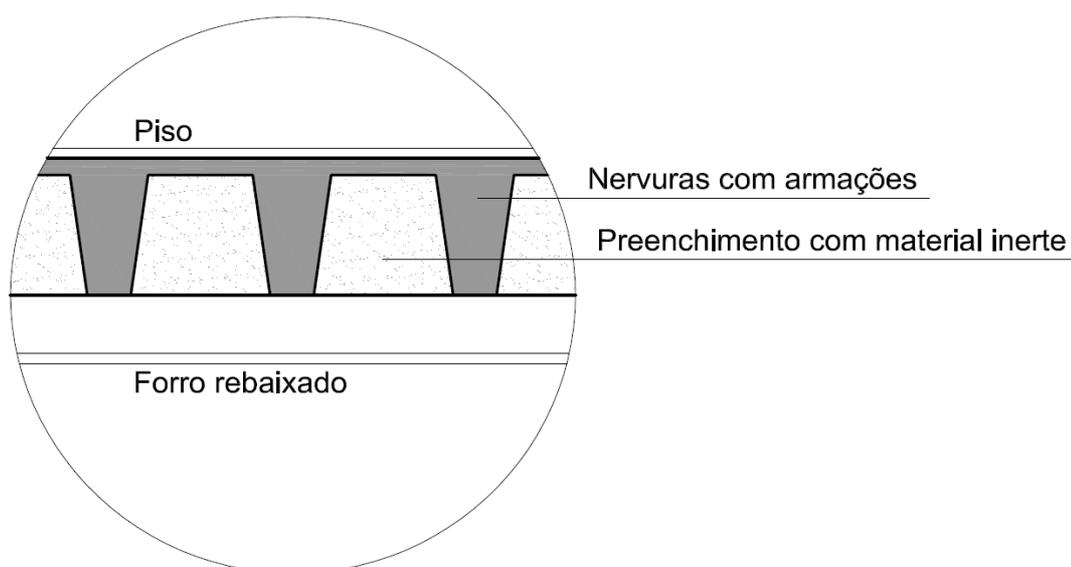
Detalhamento do sistema de laje nervurada. Fonte: Elaborado pelo autor.
